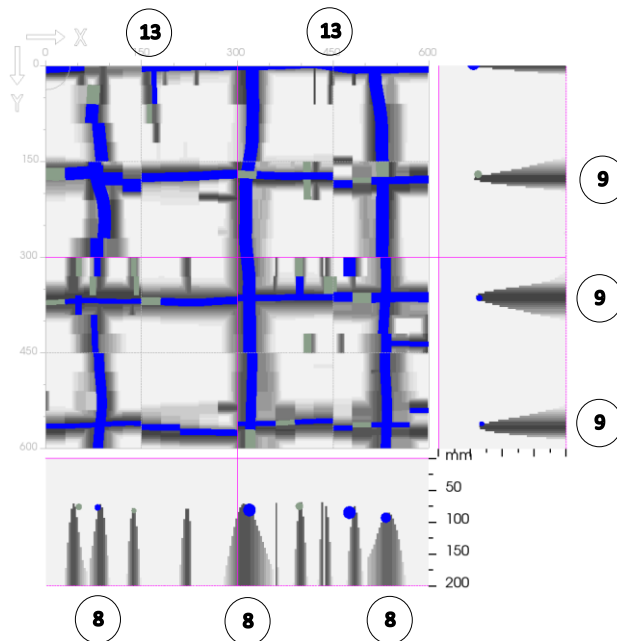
Ferrailage reconnu – Poutre Pt02
